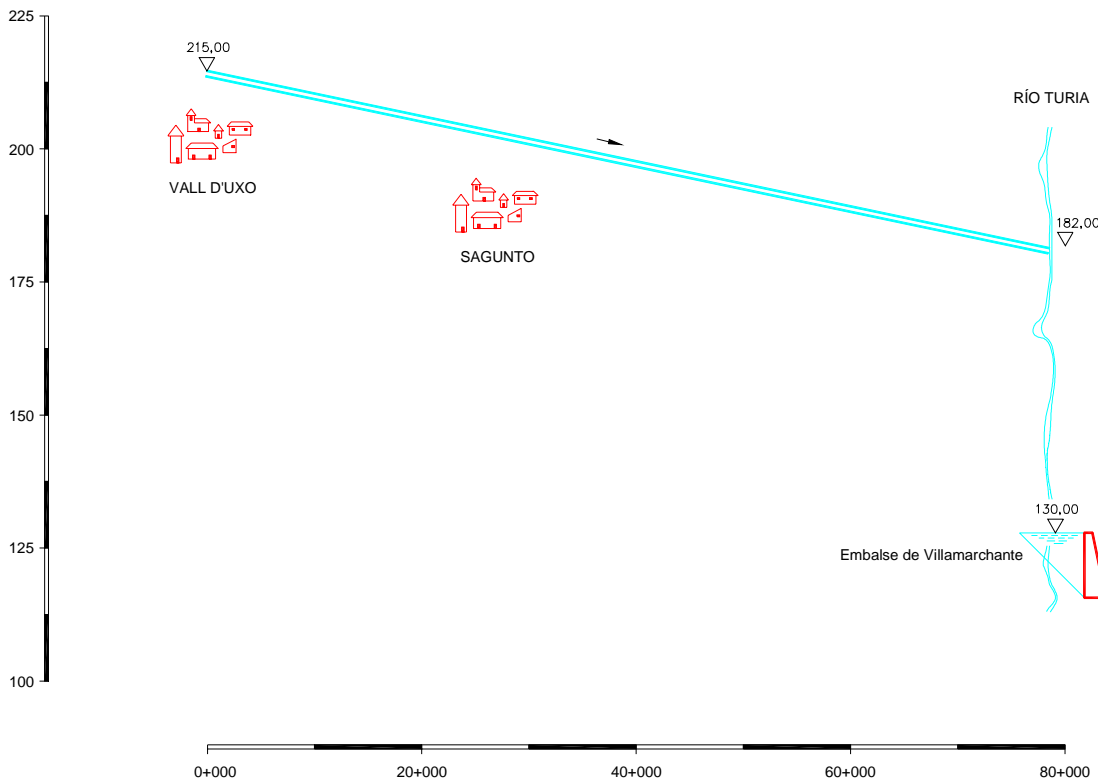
Conducción Castellón Sur - Turia. Esquema en alzado
